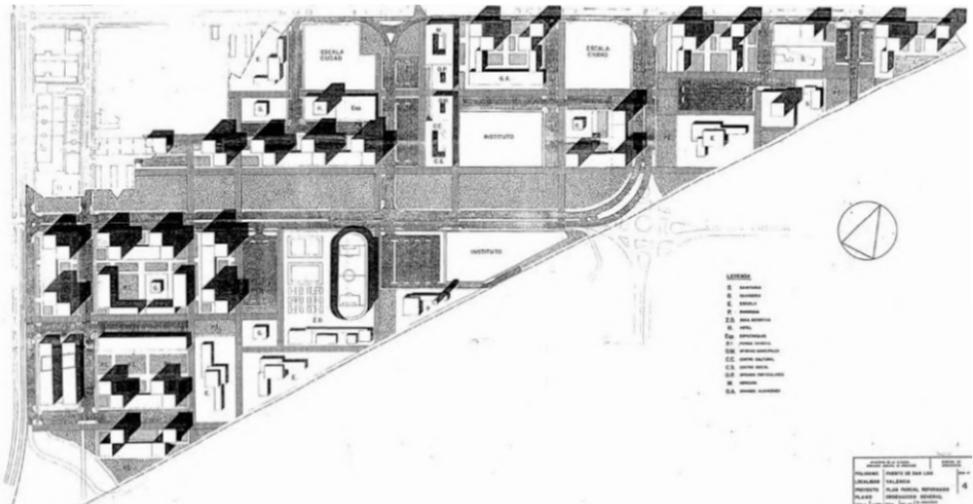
Plan Parcial Reformado del Polígono Fuente de San Luis (1969). Plano de ordenación general.
